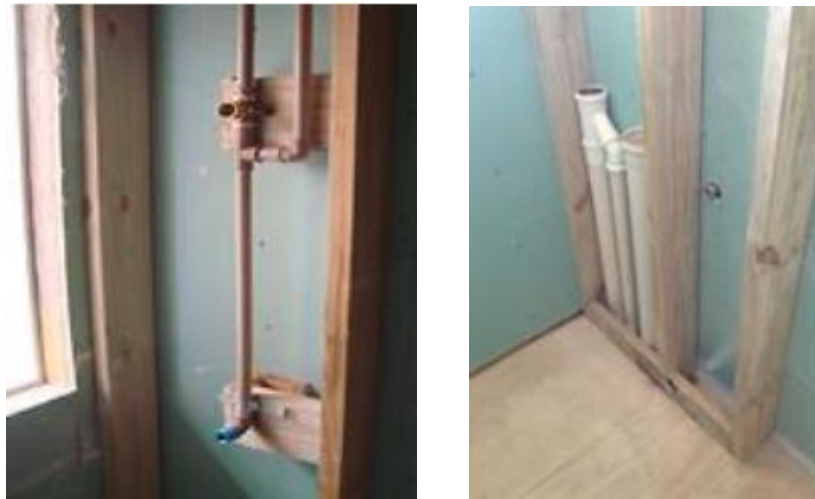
Pormenor do posicionamento das tubulações hidráulicas e sanitárias [27]
